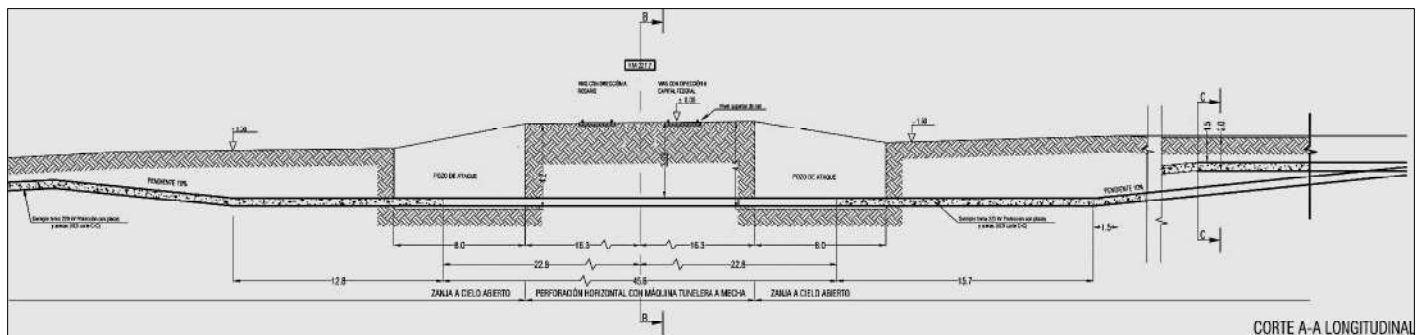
Cruce del FFCC Mitre. Vista en Corte Longitudinal
